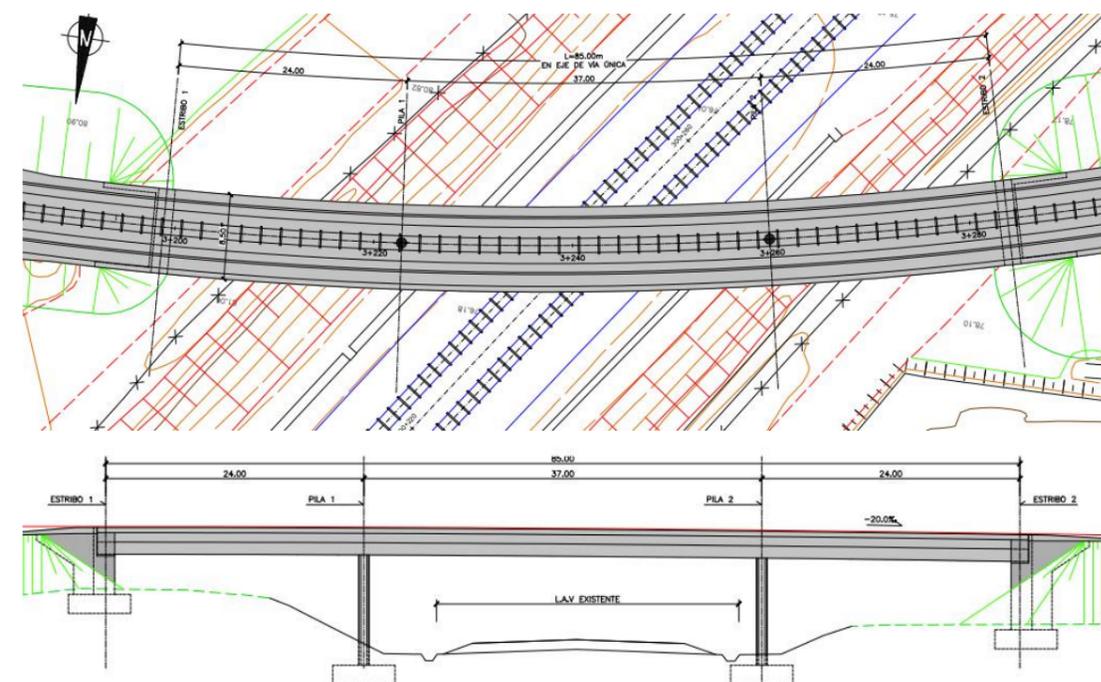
PLANTA Y ALZADO DEL VIADUCTO P.K. 3+240
